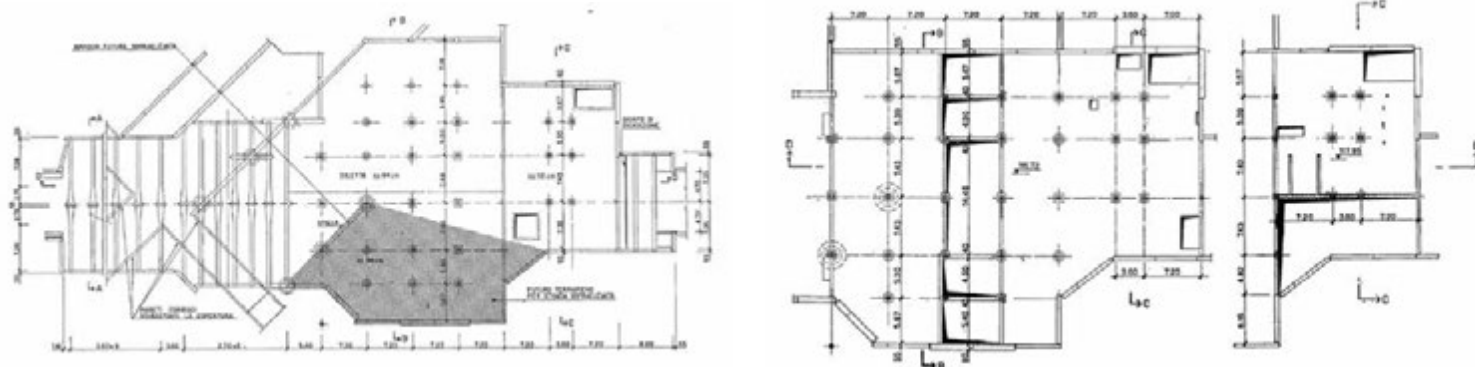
| Pianta del manufatto della Stazione Fs Centrale della MM in Milano
